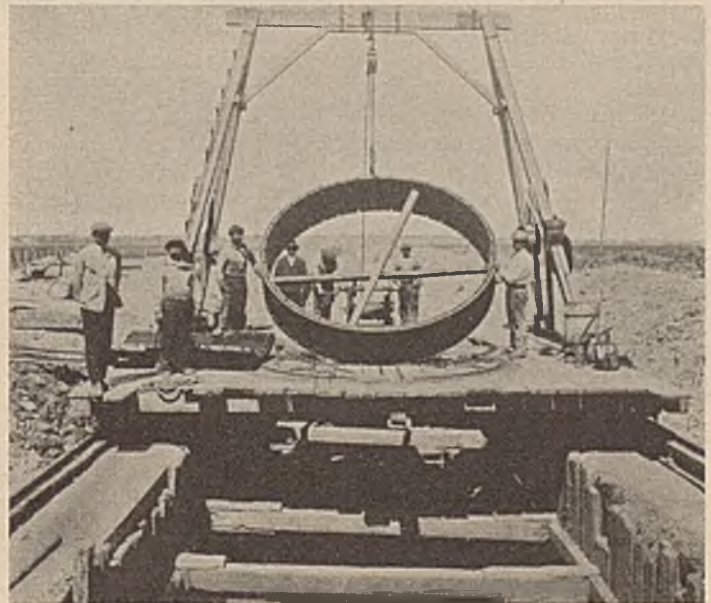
Verlegen eines aus gußeisernen Segmenten bestehenden Ringes mit Hilfe einer fahrbaren Plattform.
